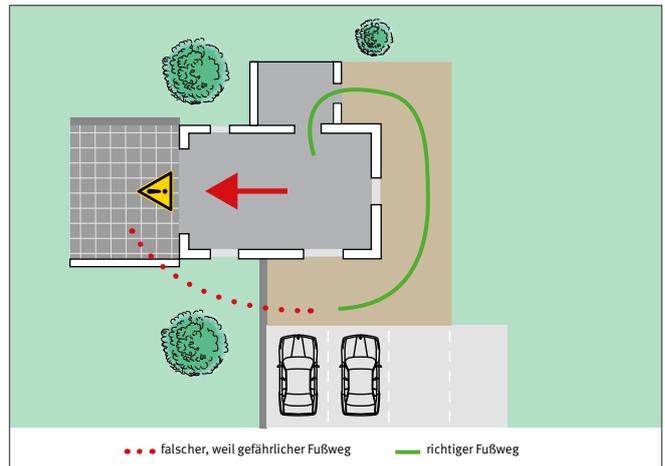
Eine Mauer versperrt den Zugang vor das Hallentor
